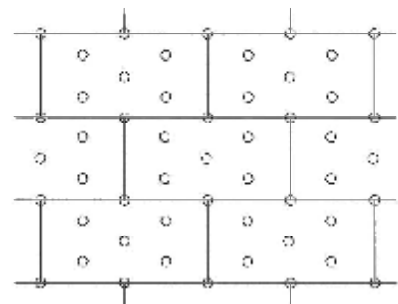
SCHÉMA ROZMÍSTĚNÍ HMOŽDINEK
